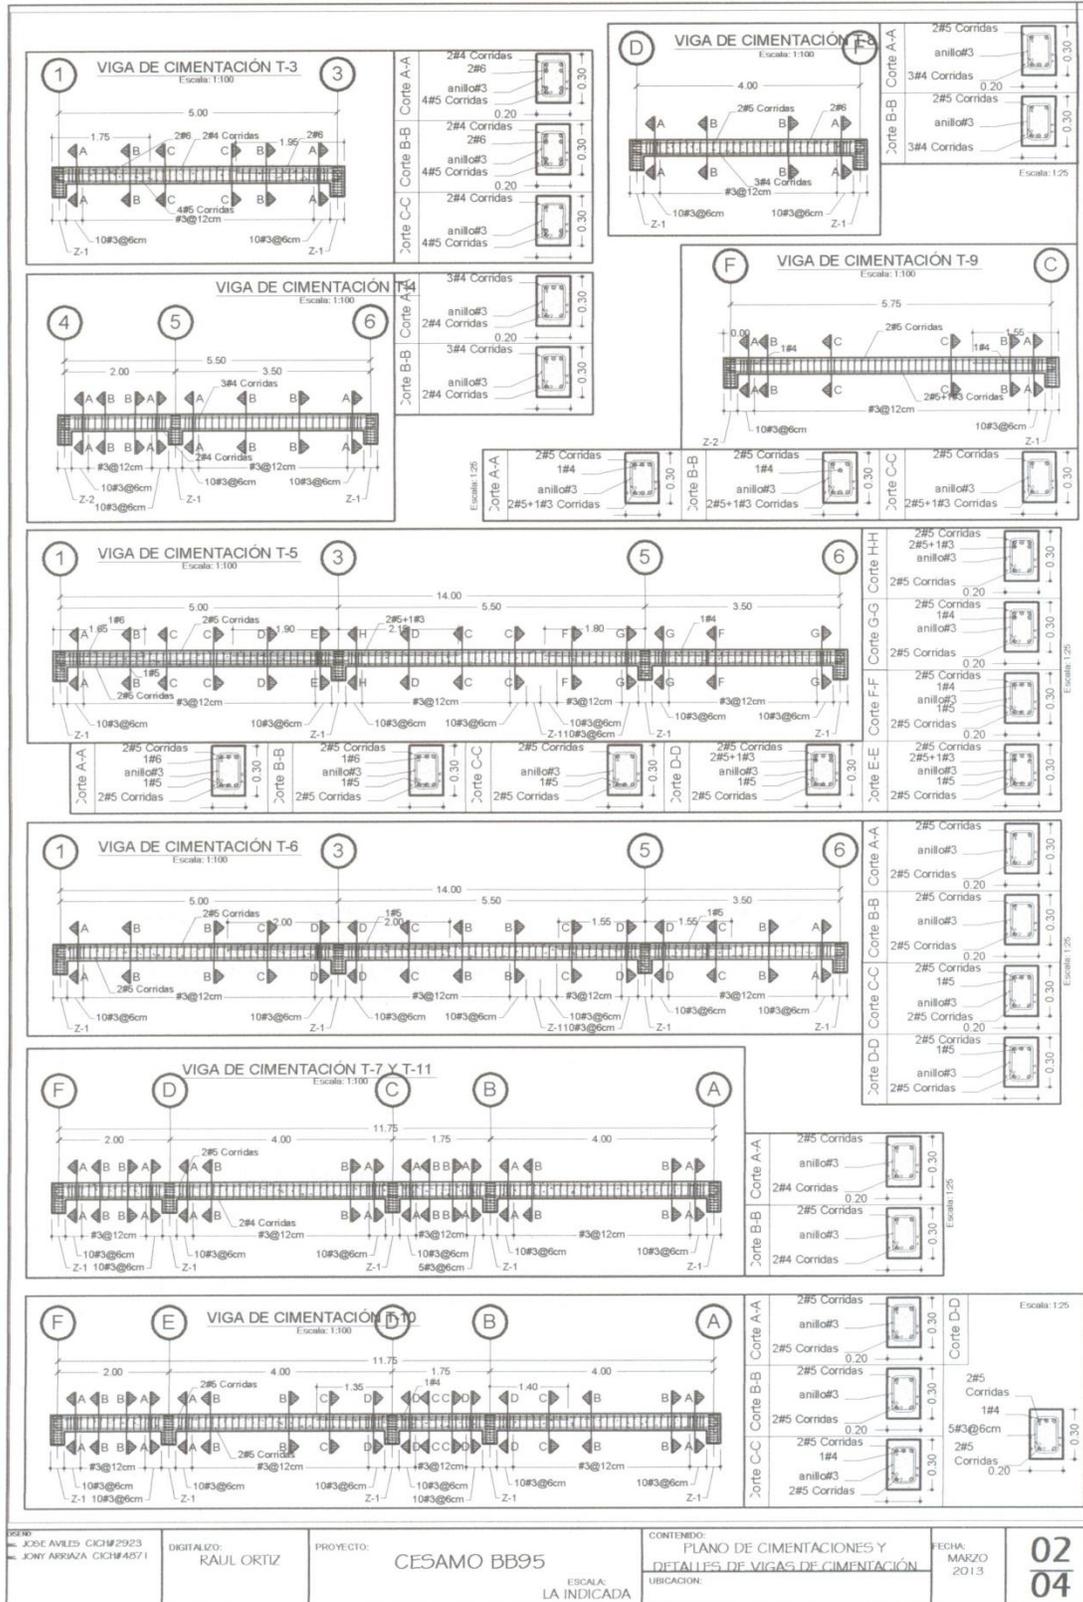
Plano Estructural de Cimentación CESAMO Tipo I Nivel 12X14m
